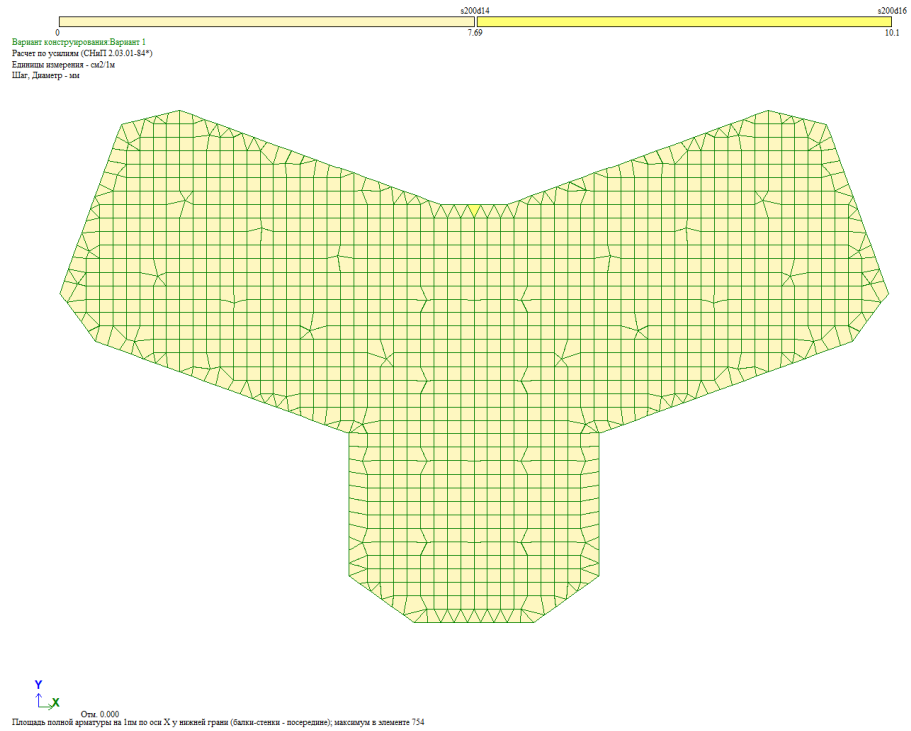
Площадь арматуры по оси X у нижней грани
